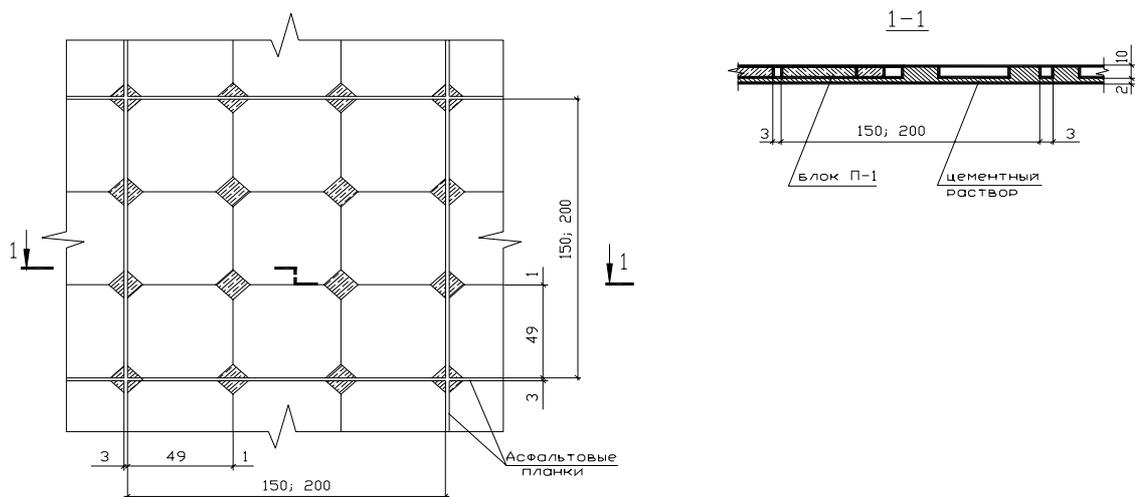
Конструкция укрепления из плит П-1 (49x49 см)
